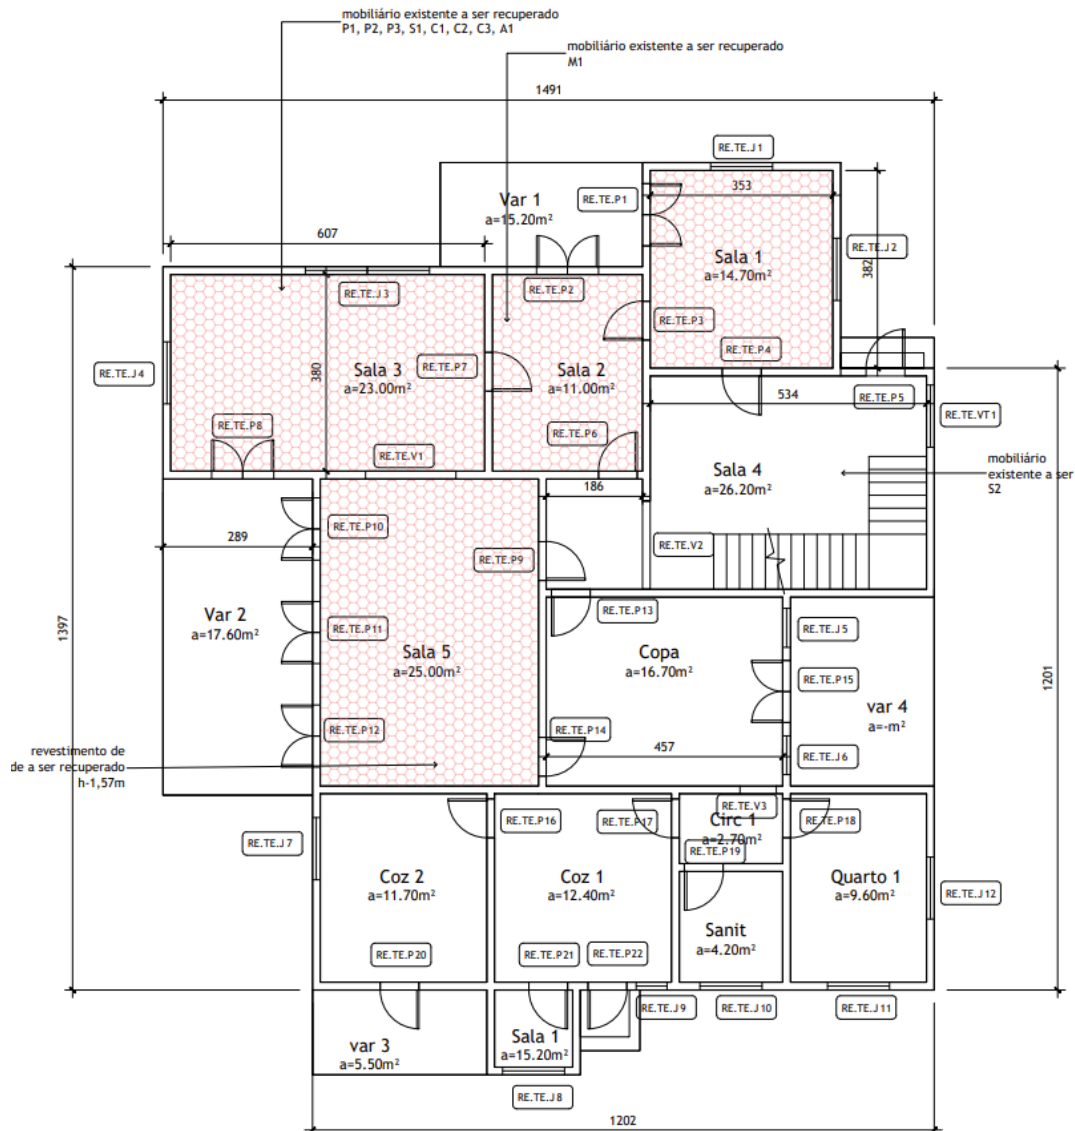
Planta baixa do Térreo [Fonte: Projeto Arkto – “Planta baixa térreo e 1º Pavimento”].
